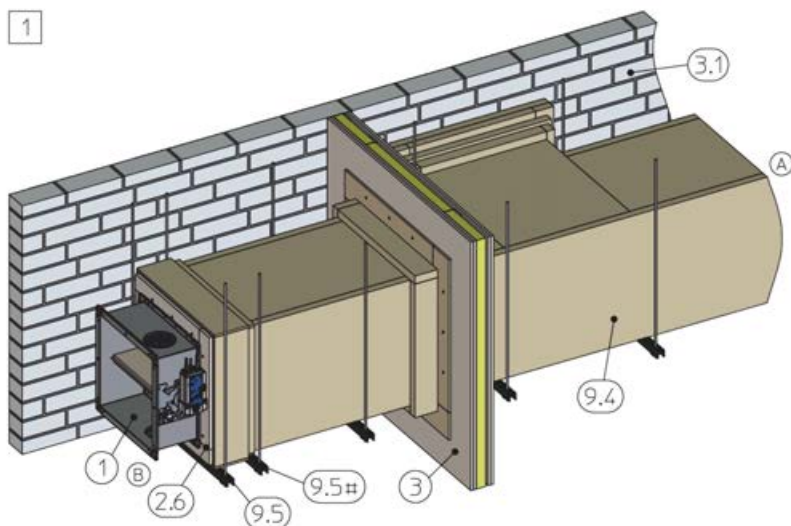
Installazione a secco lontano da pareti piene con kit d'installazione WE (applicazione su parete)
